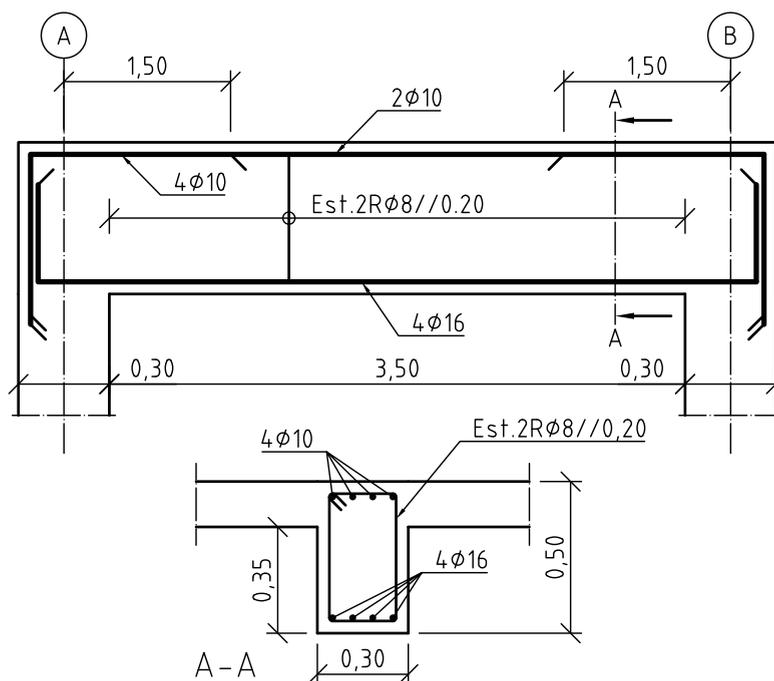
Exemplo de *desenho de projeto* das armaduras de uma viga.
